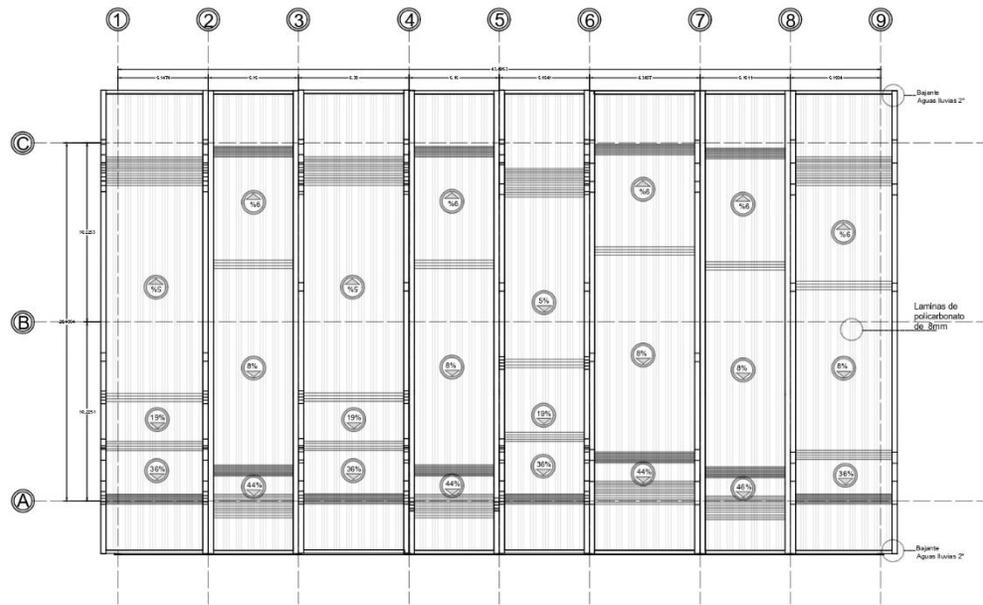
Planta Arquitectónica, Bodegas mayoristas
